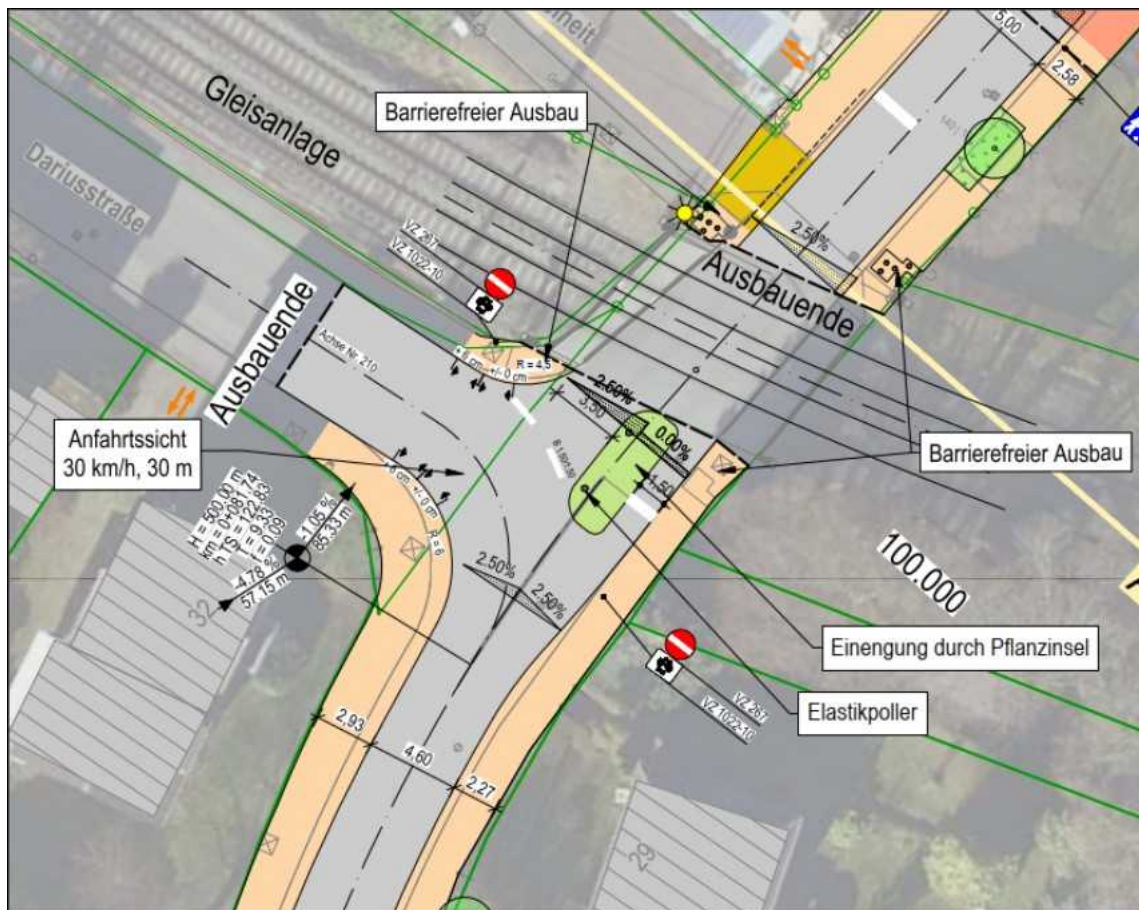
Auszug Lageplan 1 Variante 3.1.2 Ferdinand-Stucker-Straße (Stadt Bergisch Gladbach 2026)
